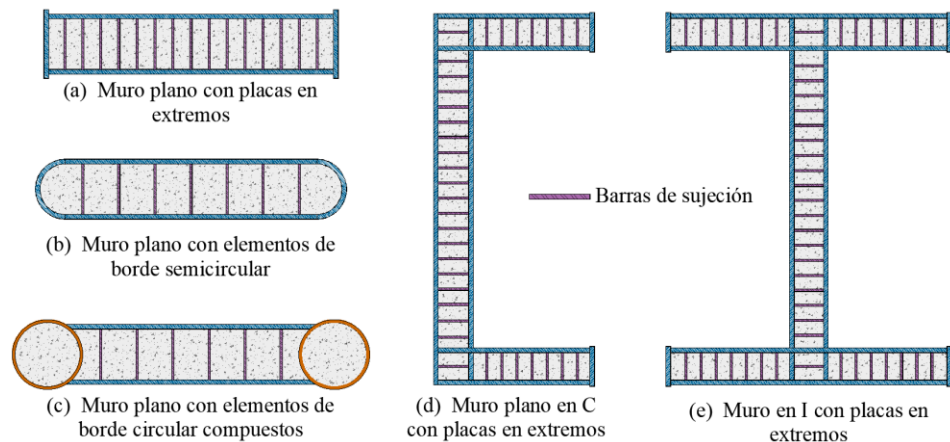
Muro de cortante compuesto con secciones huecas rellenas
